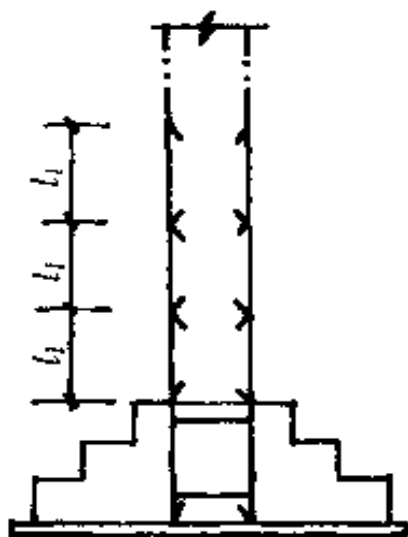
基础中插筋与柱中纵向钢筋搭接位置(4)
